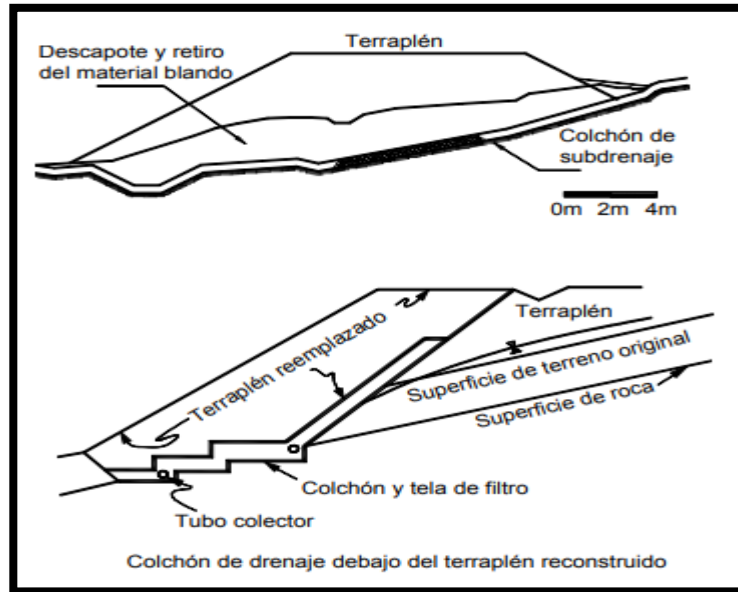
Colchones de drenaje colocados debajo de un terraplén
